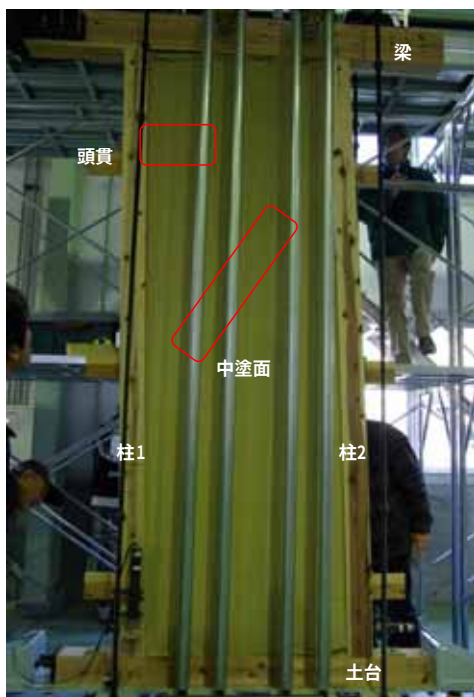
中塗り側 1/25rad セン断ひび割れ、頭貫に沿ったひび割れ
